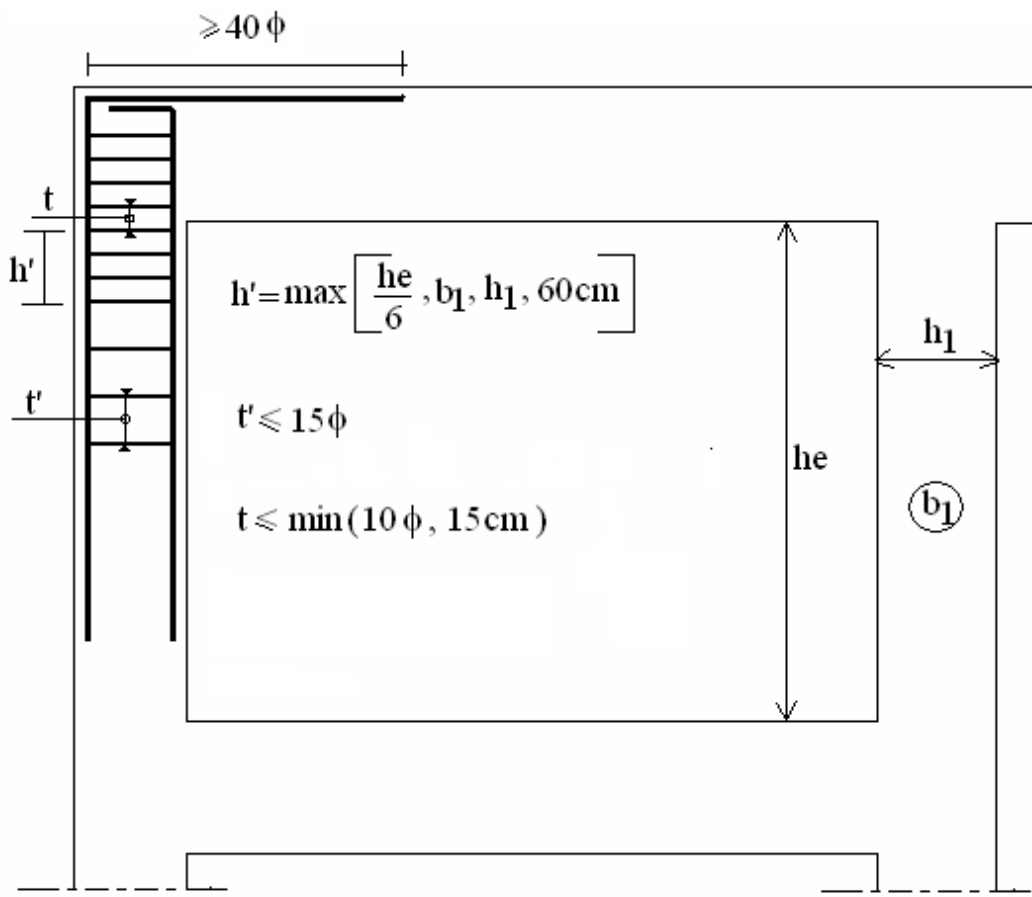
disposition constructive pour le ferrailage des poteaux (RPA99)
